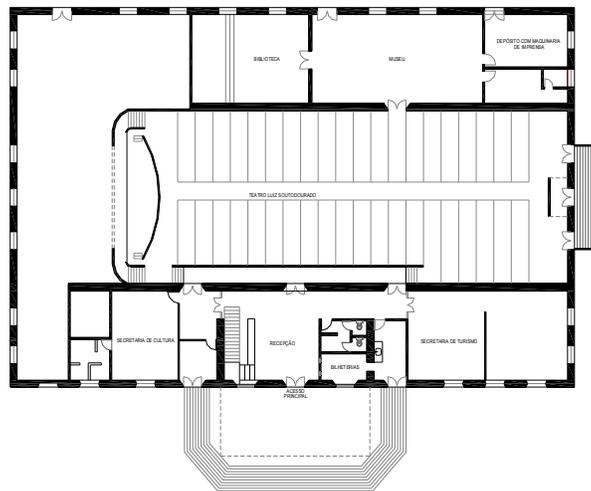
Planta Baixa do pavimento térreo - situação atual da edificação; sem escala
